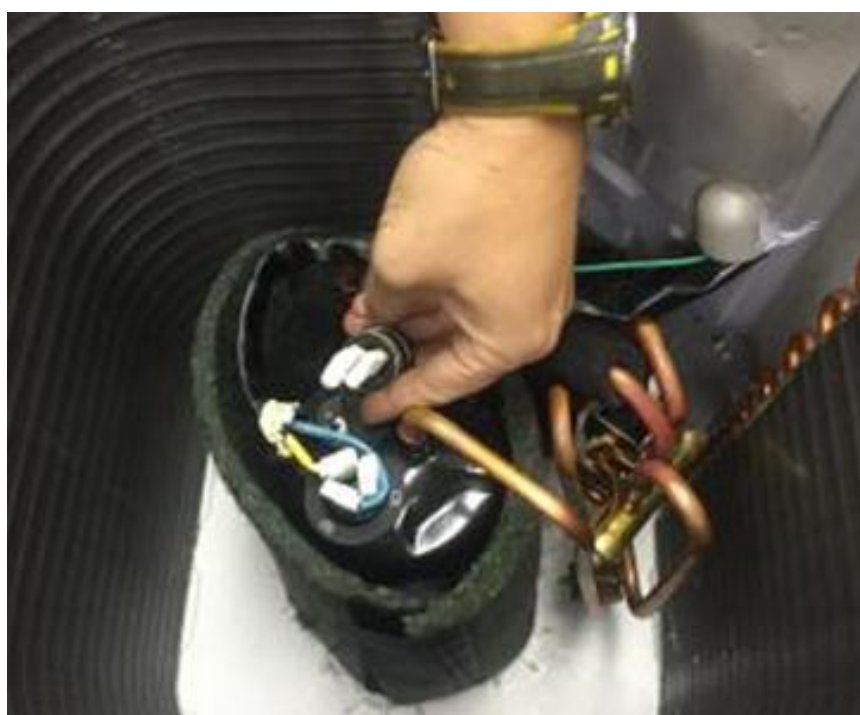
Inspeção do Compressor, protetor térmico e tubulações
